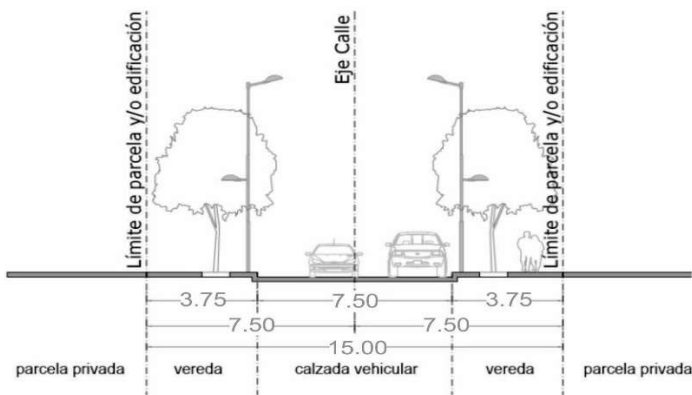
Sección transversal de Vías Calles Tipo 10.
